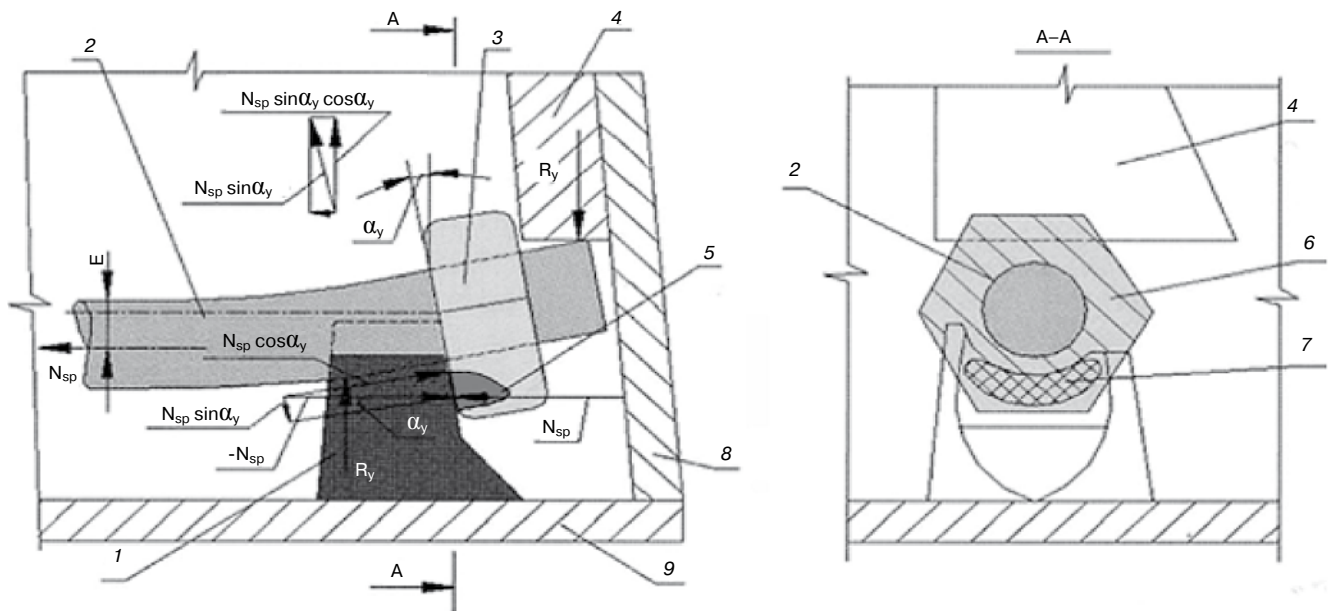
Схема усилий в зоне опирания концевой арматуры на упор с наклонной опорной поверхностью: 1 – внутренний упор; 2 – напрягаемый стержень; 3 – внутренний анкер; 4 – фиксатор положения напрягаемого стержня; 5 – напряжения в зоне опирания анкера на упор; 6 – площадь опирания анкера на бетон; 7 – площадь передачи усилия натяжения с арматуры на упор; 8 – борт формы; 9 – поддон формы
